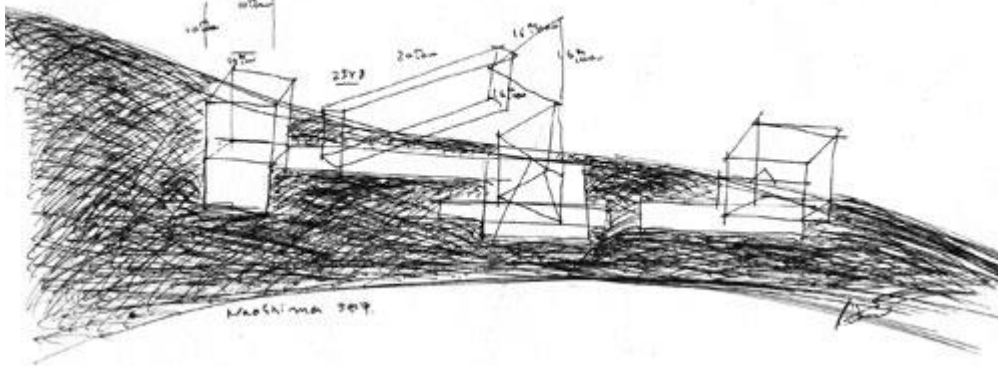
Croquis de las estructuras enterradas del Chichu Art Museum en Naoshima, Japón de Tadao Ando
